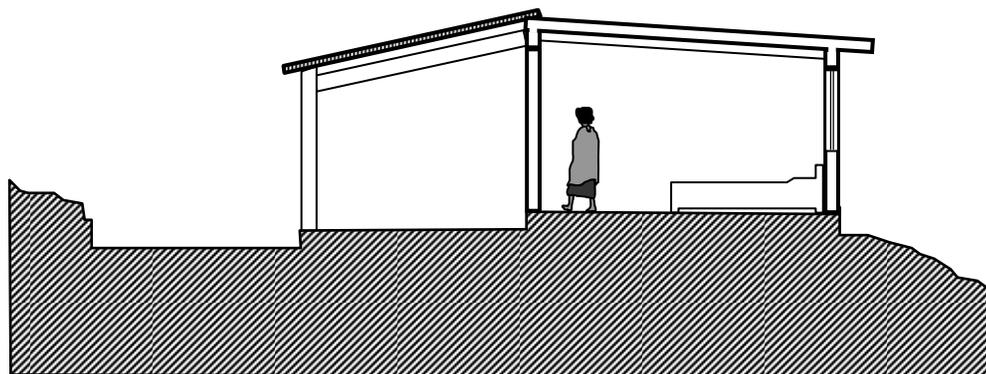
Corte de elementos constructivos que emplean concreto armado y adobe, para su edificación. (d.a.)
